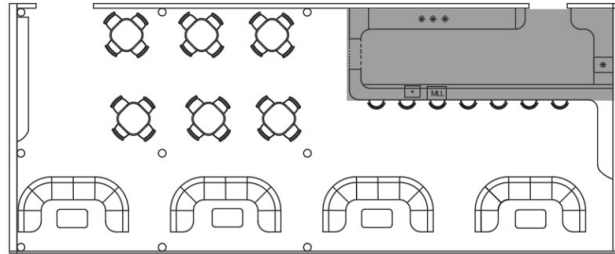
Identificação da Zona de Trabalho DECK em planta (Camila Schmidt,2025)
